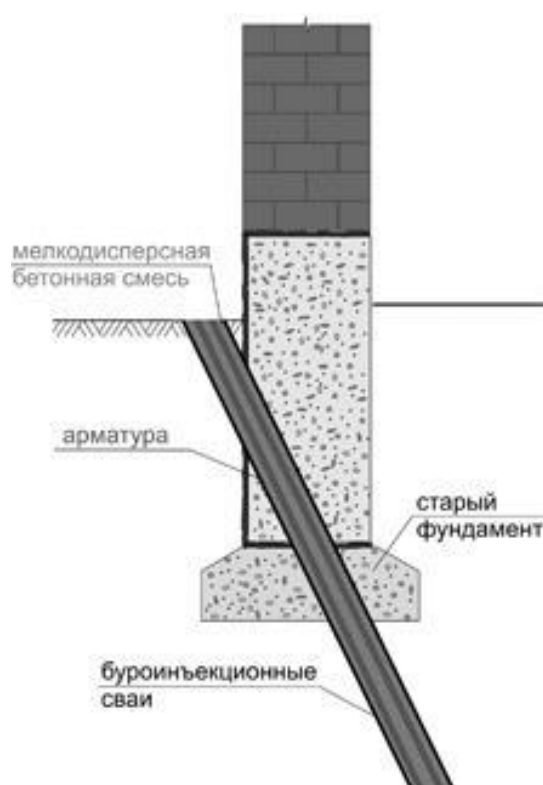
Устройство буроинъекционной сваи сквозь старый фундамент
